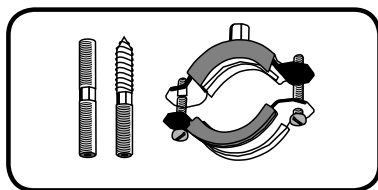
б - Металлические хомуты с резиновой вставкой используются преимущественно для неподвижных закреплений.
